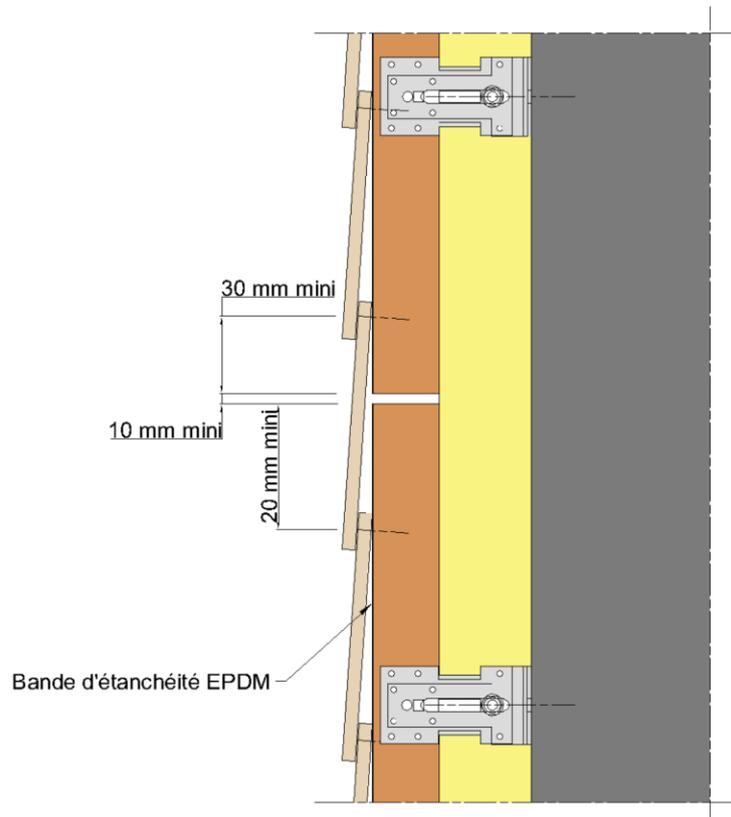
Fractionnement de l'ossature – pose horizontale des lames CEDRAL LAP et fixation en rive haute (tous les 5,40 m de hauteur maximum)
